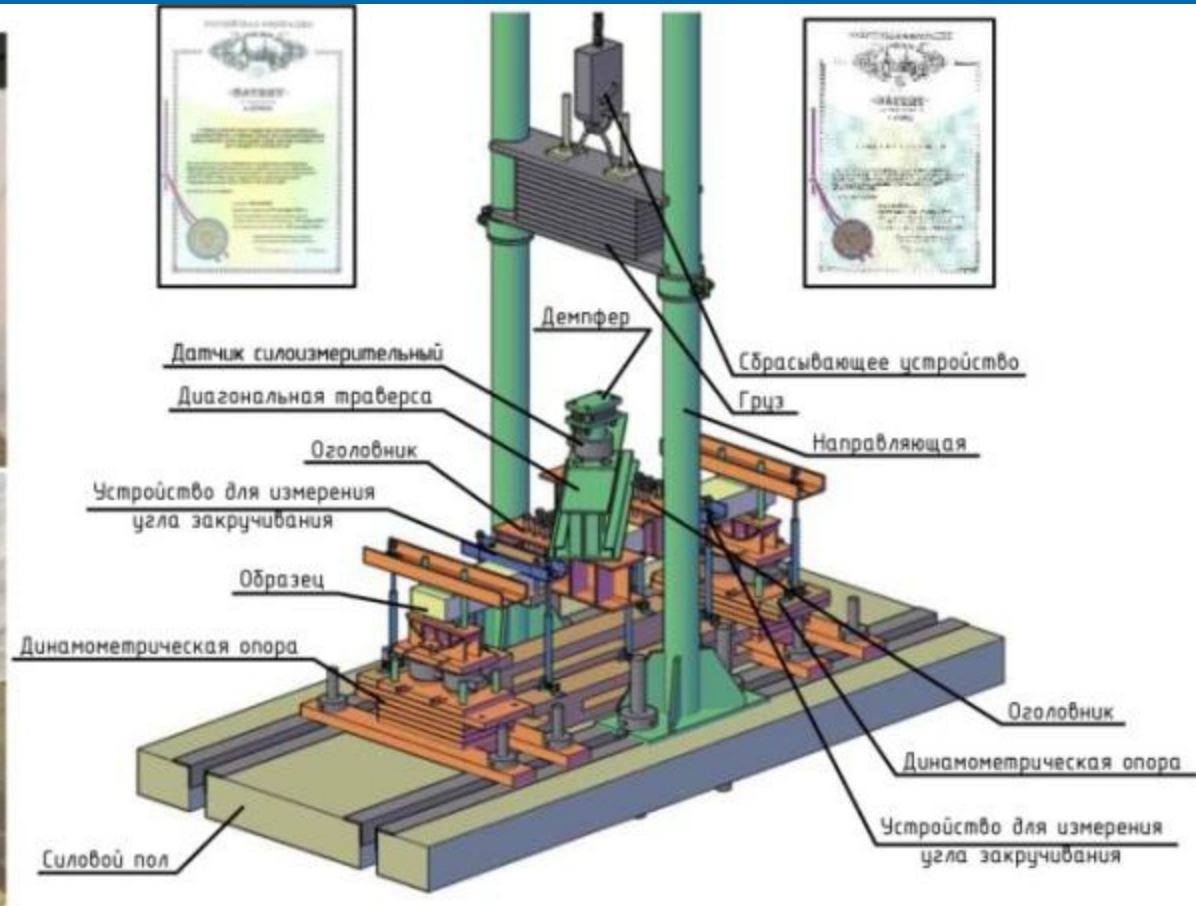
Общий вид установки-стенда с испытываемой балкой на изгиб с кручением
